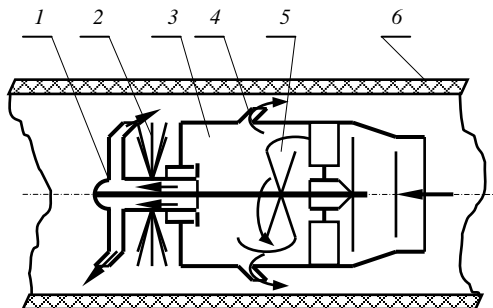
Схема гидромеханической головки: 1 – корпус; 2 – турбинка; 3 – валик; 4 – ерш; 5 – тангенциальные сопла; 6 – дрена
